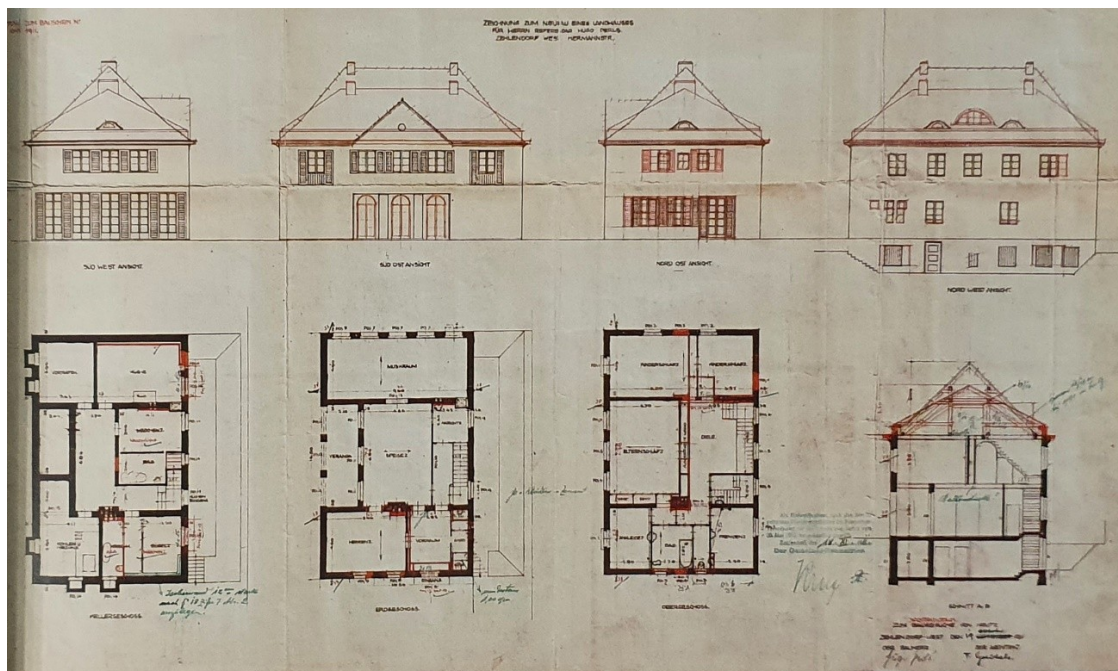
Elevações, plantas e corte, Casa Perls, 1911
